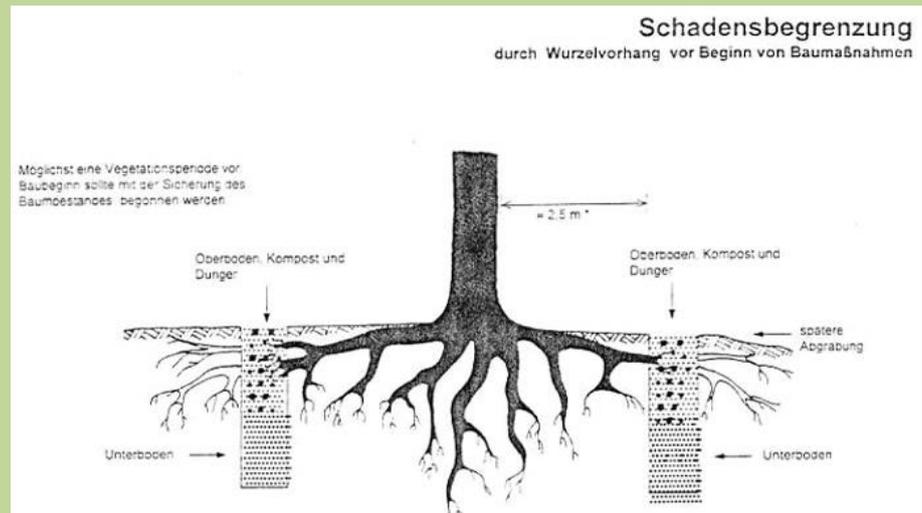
Baumschutz auf Baustellen, Schema Wurzelvorhang, Urheber unbekannt
